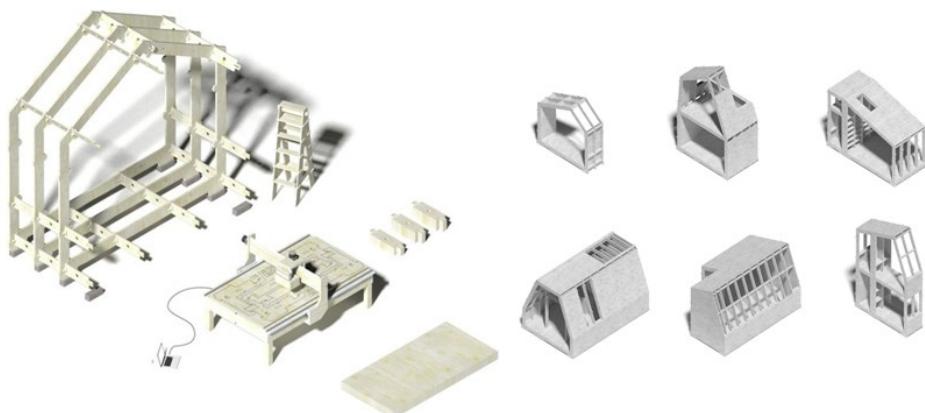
Vila verde koncept; izvor: autor prema: Alejandro Aravena – Villa Verde concept
